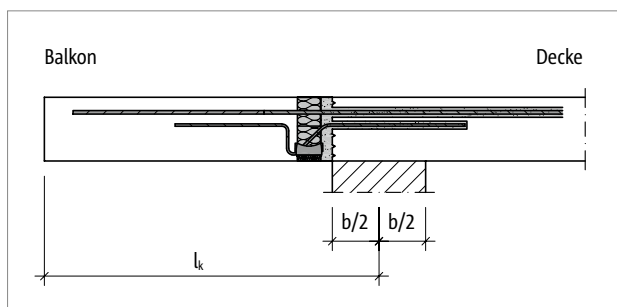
Schöck Isokorb® RT Typ K: Statisches System; direkte Lagerung
